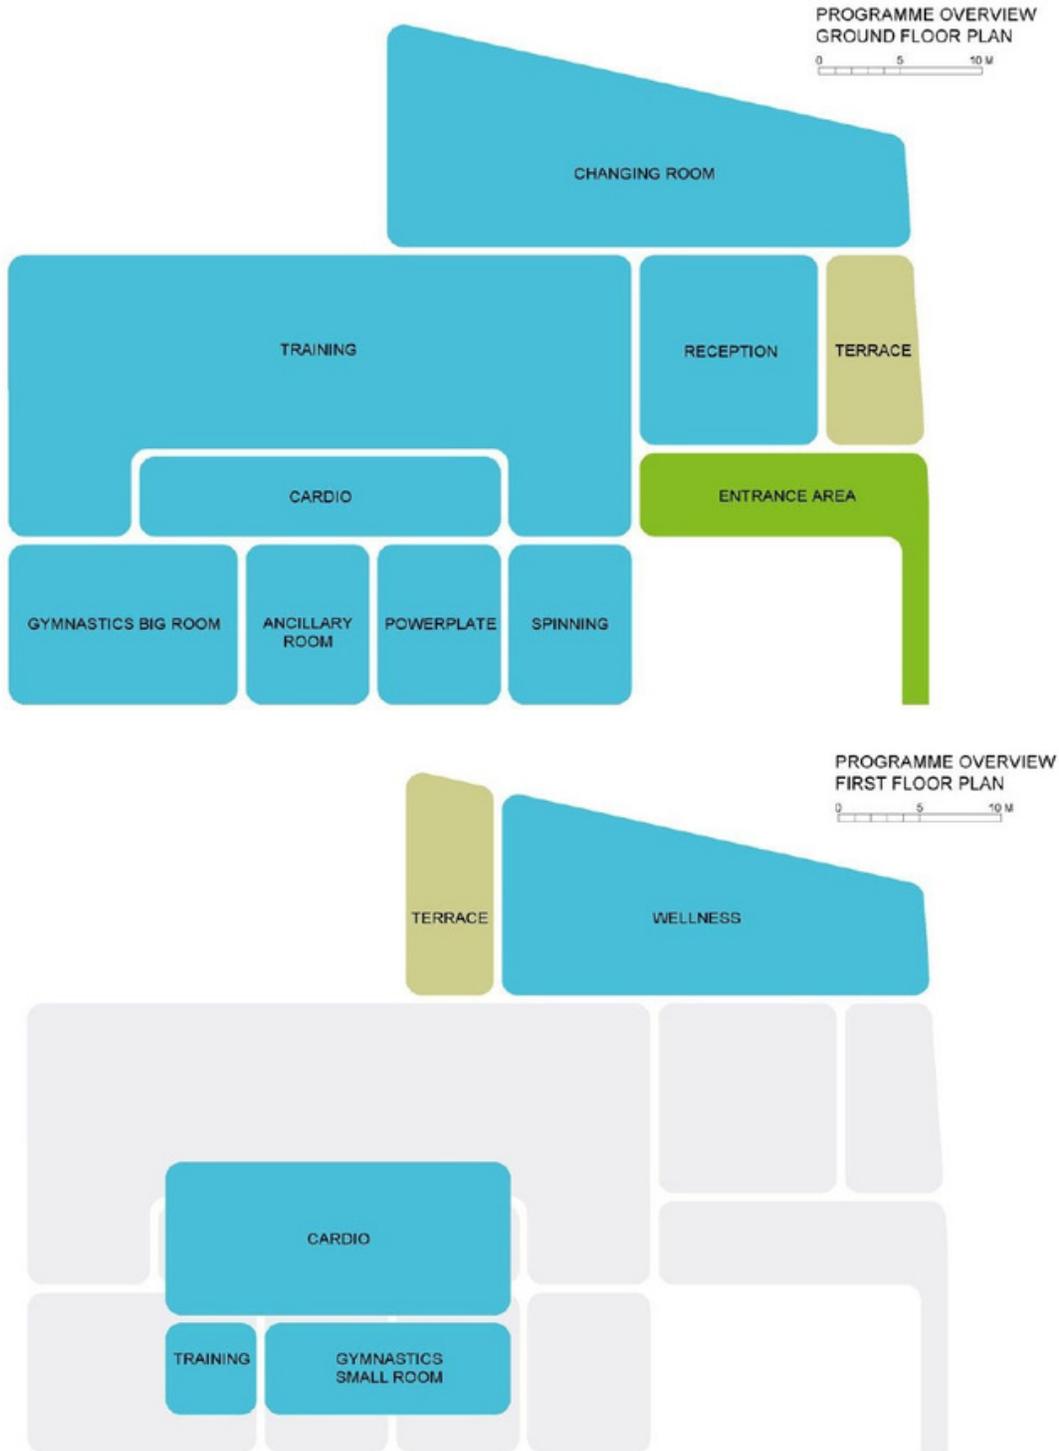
Distribución de áreas en planta baja y alta. Fuente: https://www.archdaily.mx/mx/947809/gimnasio-mfitness-smertnik-kraut?ad_source=search&ad_medium=projects_tab, 2020
